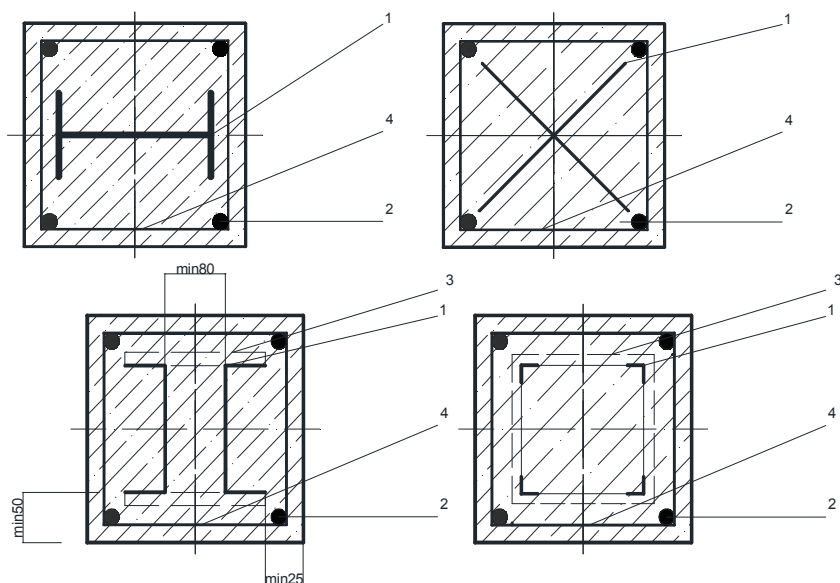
Сечения колонн с жесткой арматурой, где: 1 – арматура жесткая; 2 – то же, гибкая; 3 – планка; 4 – хомут
